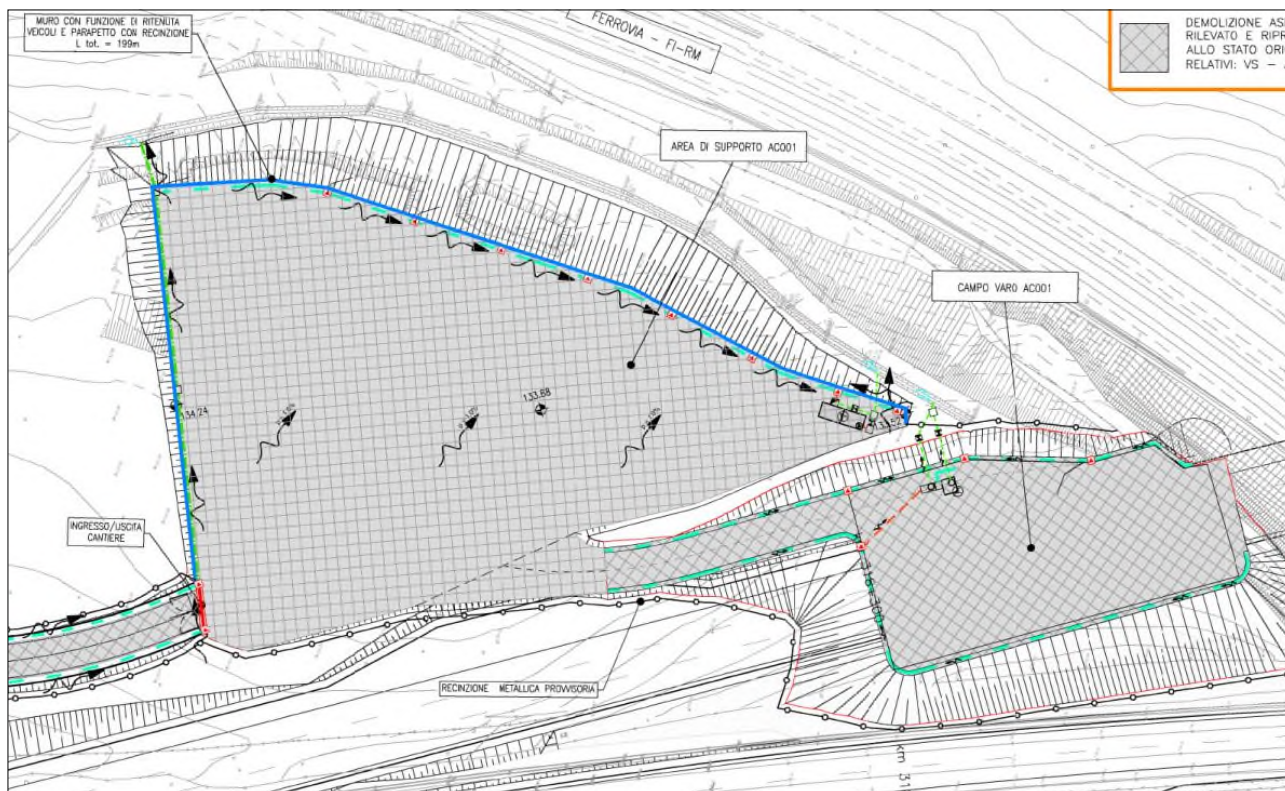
Disposizione dell'area di supporto AC01 per nuovo viadotto Arno (stralcio planimetrico da GEN5323-0)
